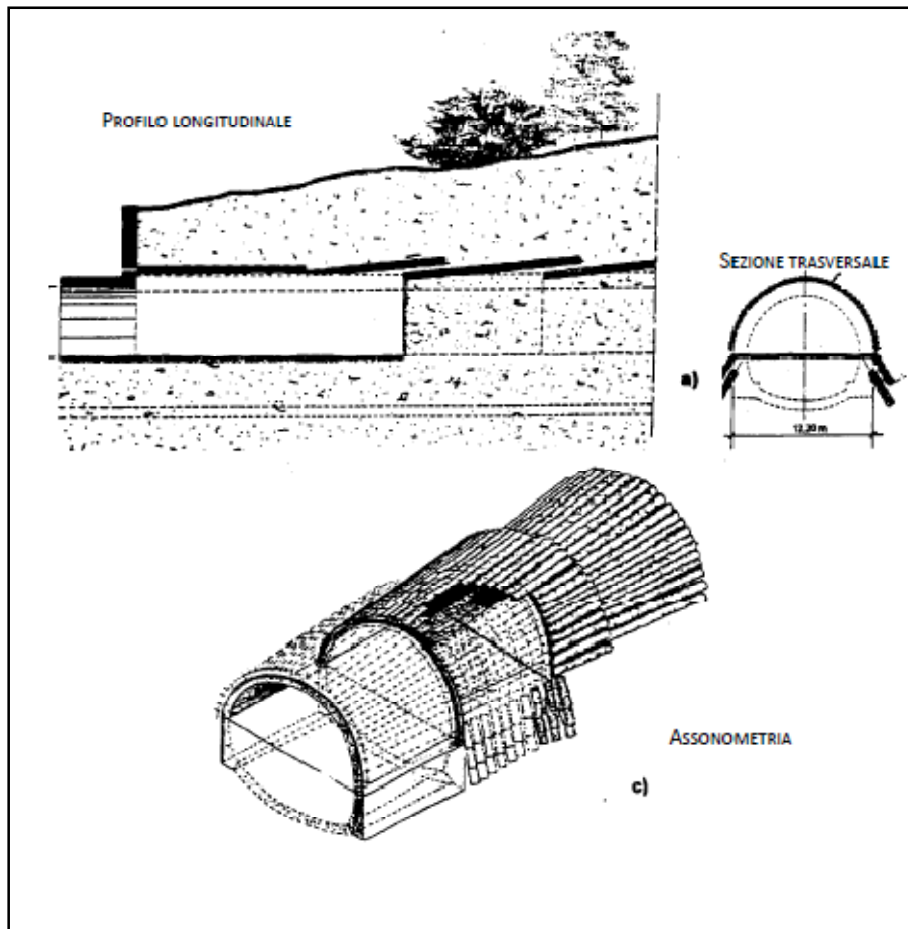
Trattamenti sub-orizzontali eseguiti con la tecnica del jet-grouting: a) sezione longitudinale; b) sezione trasversale; c) assonometria (Golinelli 1991)
